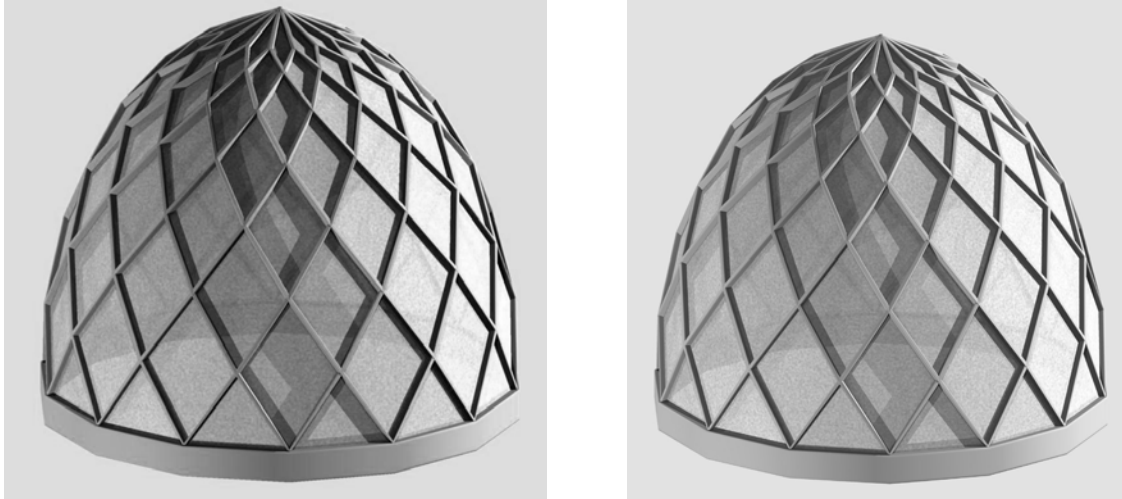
Modelamiento del proyecto Glass Pavilion de Bruno Taut.
